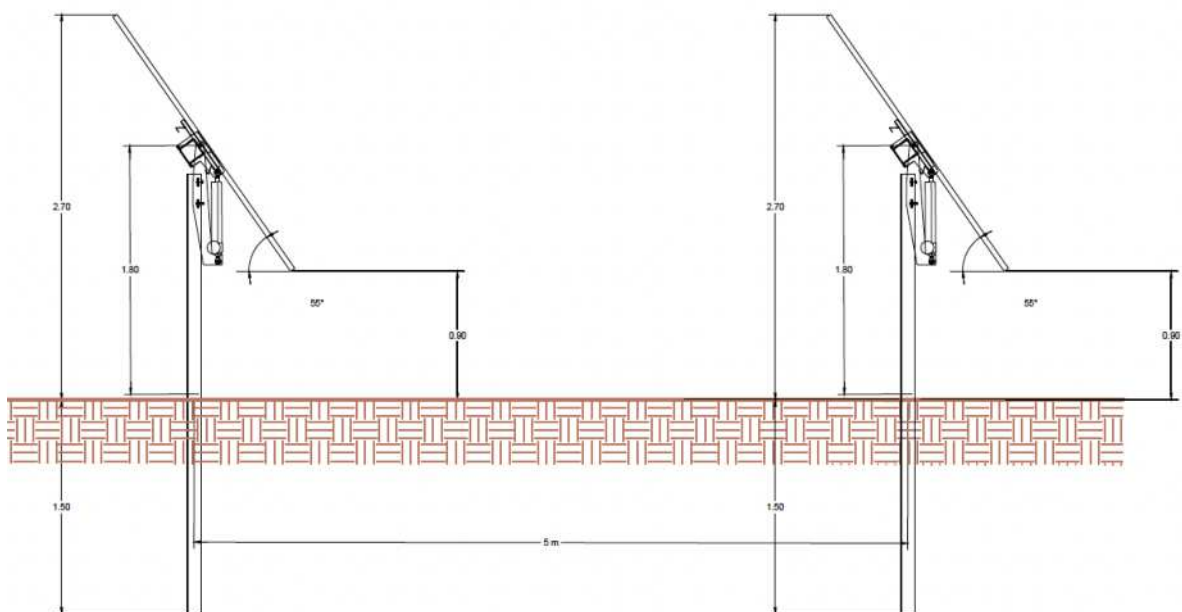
Layout impianto fotovoltaico, Settori A, B e C.
